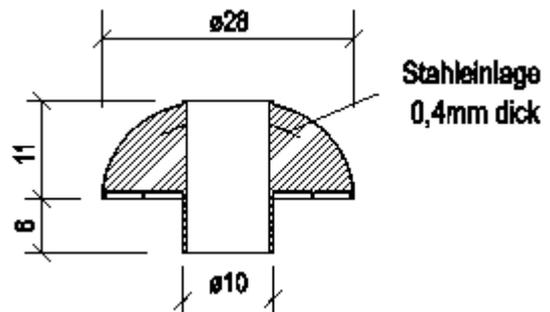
Pilzkopfdichtung aus Kunststoff mit Stahleinlage für die Sechskant-Holzschraube nach Bild 1 und für Stahlhaken
